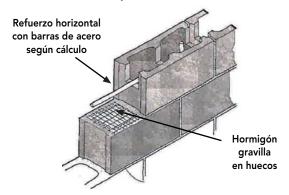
La instalación de los bloques de hormigón como sobrecimiento debe ceñirse a las especificaciones de cálculo e indicaciones del fabricante.
